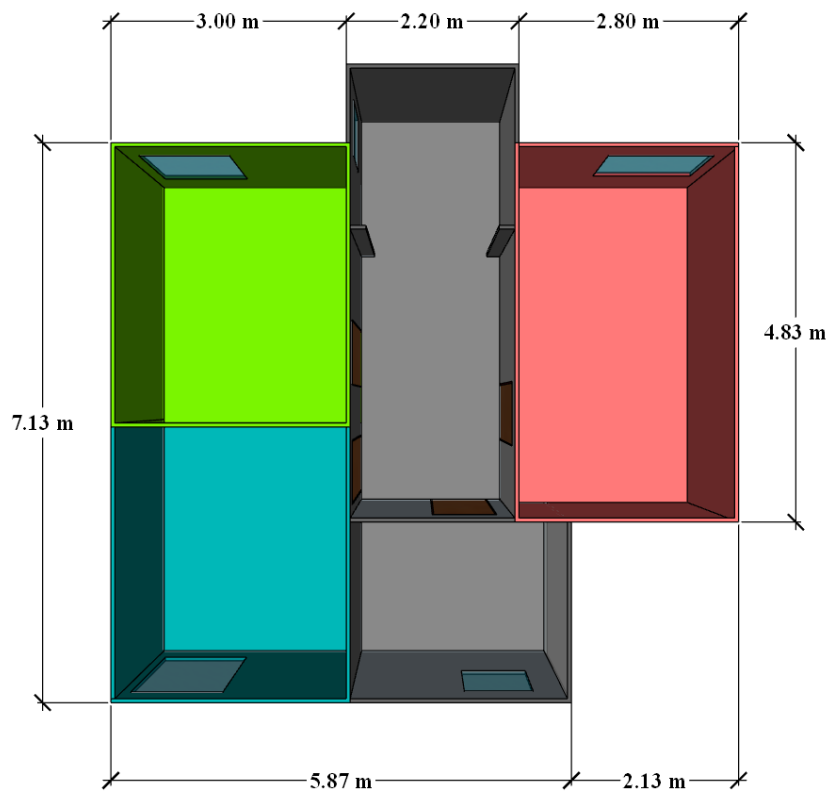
Dimensiones de las zonas térmicas de la planta alta
